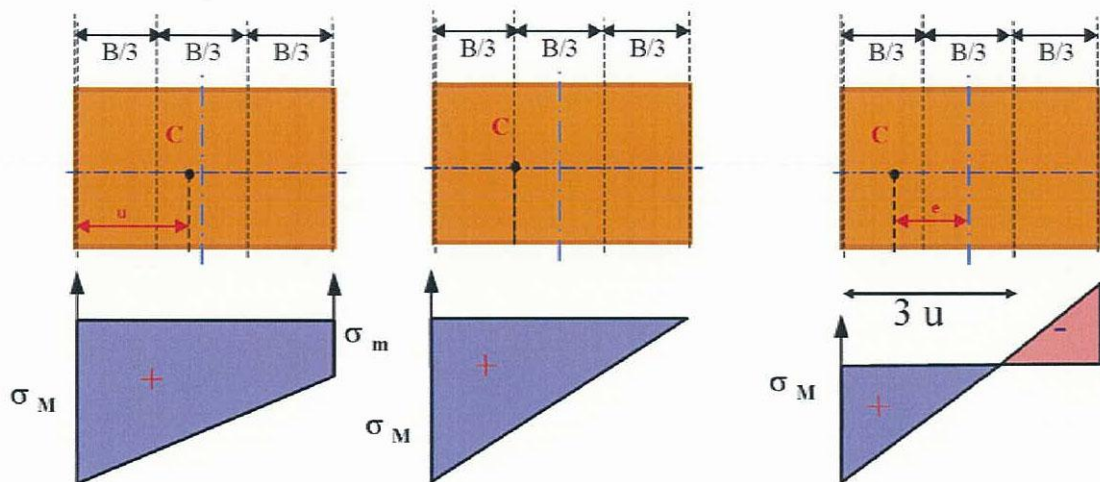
Sezione basale della palificata. Centro di sollecitazione (a) interno al nocciolo centrale della sezione di base; (b) coincidente con l'estremo del nocciolo centrale; (c) interno al terzo medio di valle.
